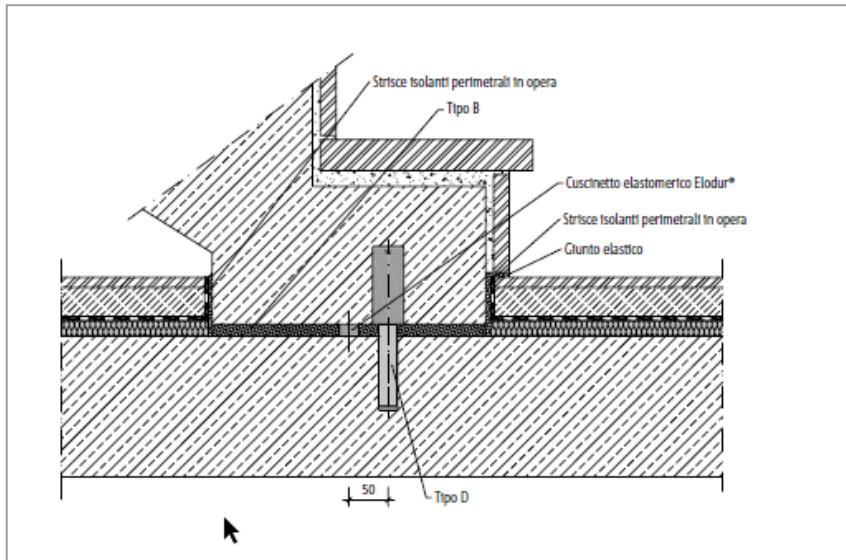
Schöck Tronsole® tipo B + tipo D: sezione costruttiva
